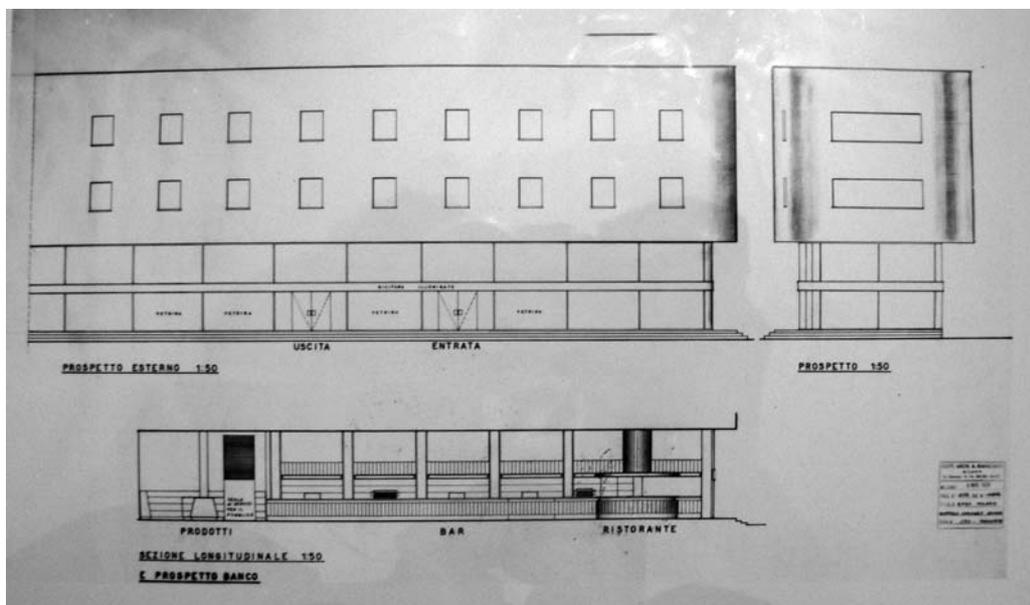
Prospetto e sezione dell'edificio di Genova (AAB)
